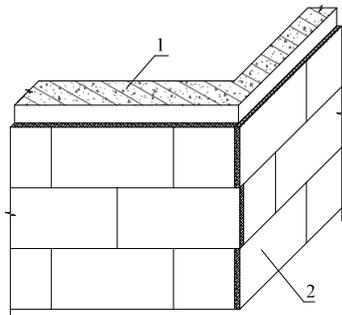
墙角保温板排板示意（尺寸单位：mm）
